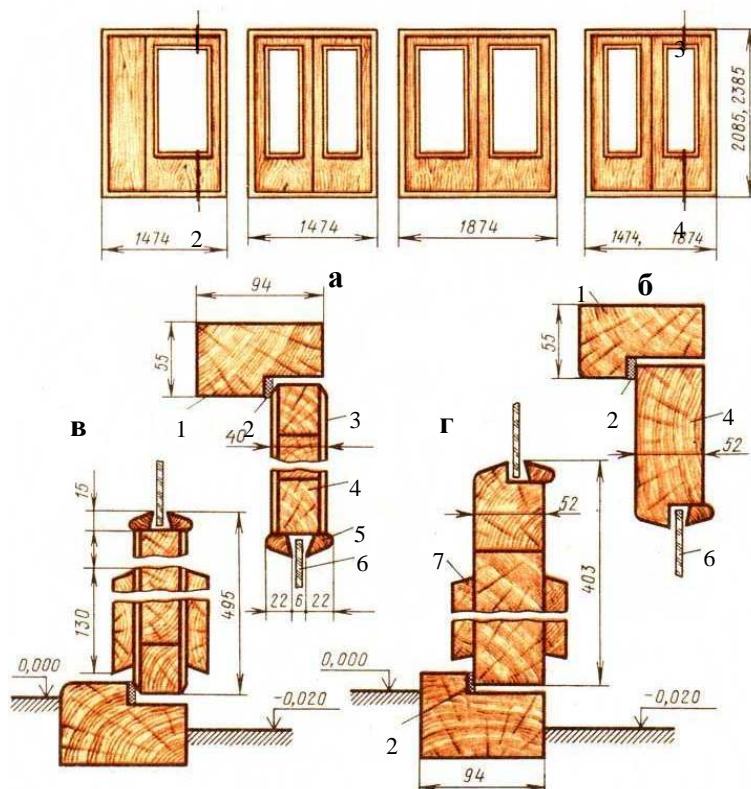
Дверні блоки для житлових і громадських будівель: а – щитові; б – рамні; в – переріз щитових дверей; г – переріз рамних дверей; 1 – брусок коробки; 2 – ущільнювальна прокладка; 3 – облицювання із твердих деревоволокнистих плит; 4 – полотно дверей; 5 – штапик; 6 – скло; 7 – захисна планка
